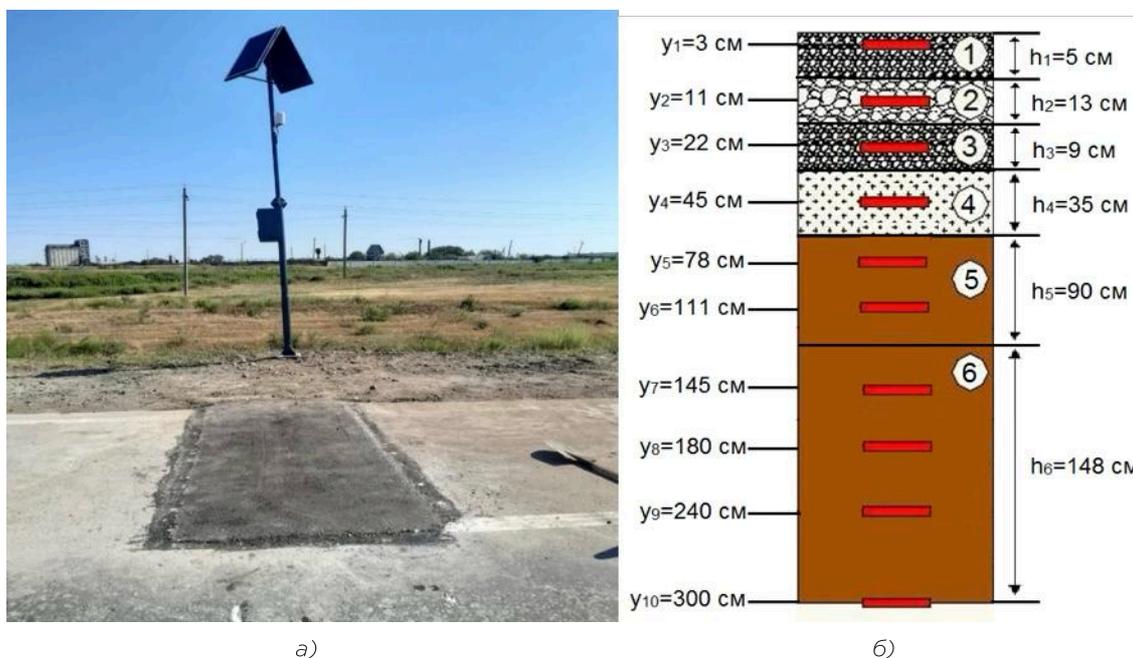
Внешний вид передающей антенны вблизи г. Костанай а) и схематический вид дорожной конструкции б)
